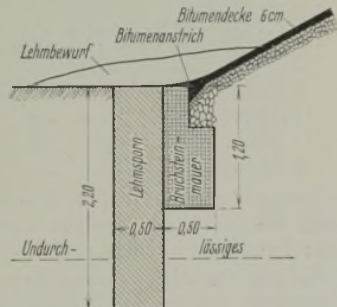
Untere und seitliche Begrenzung der Asphaltabdichtung Ameckerdamm.
